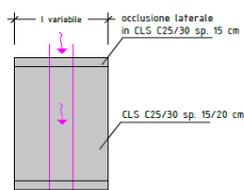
TIPOLOGIA DI ATTRAVERSAMENTO STADALE E CAVALCAFOSSO IN PROGETTO
